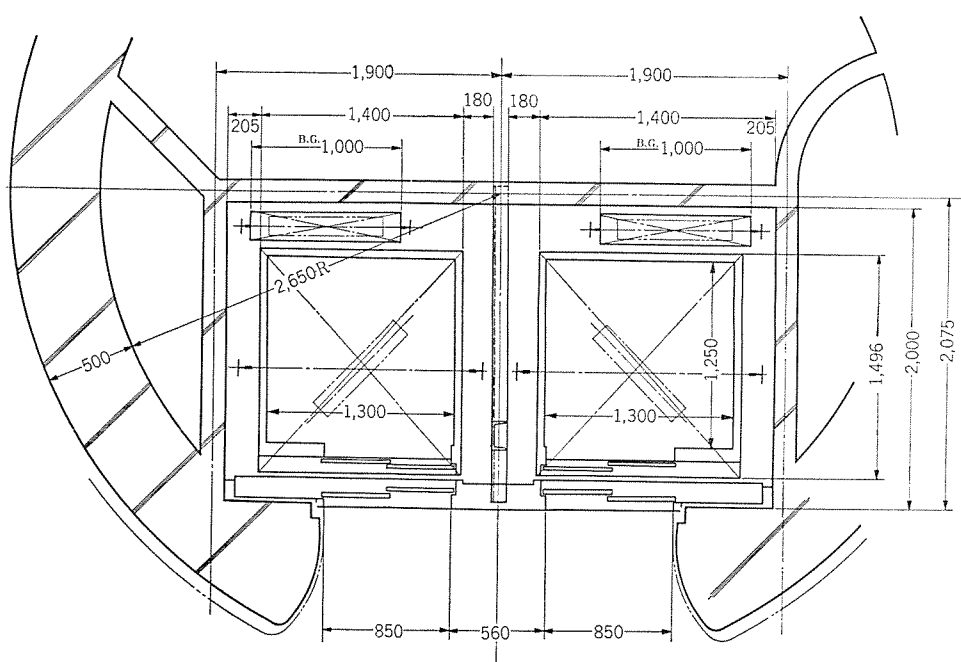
昇降路平面図 Fig 3.1 Plan of hoist way.
